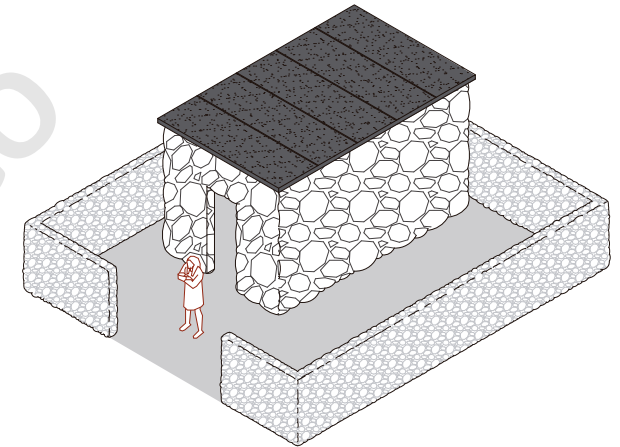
dibujo sistema constructivo. Elaboración propia.
